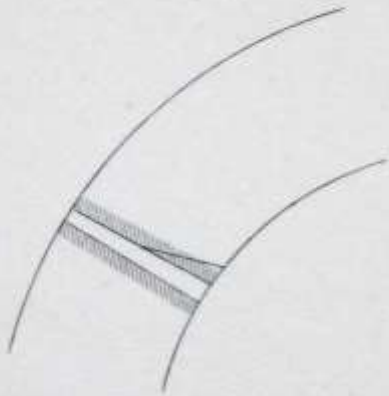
Eingeschalte Betonlamellen der Brücke bei Britz.
